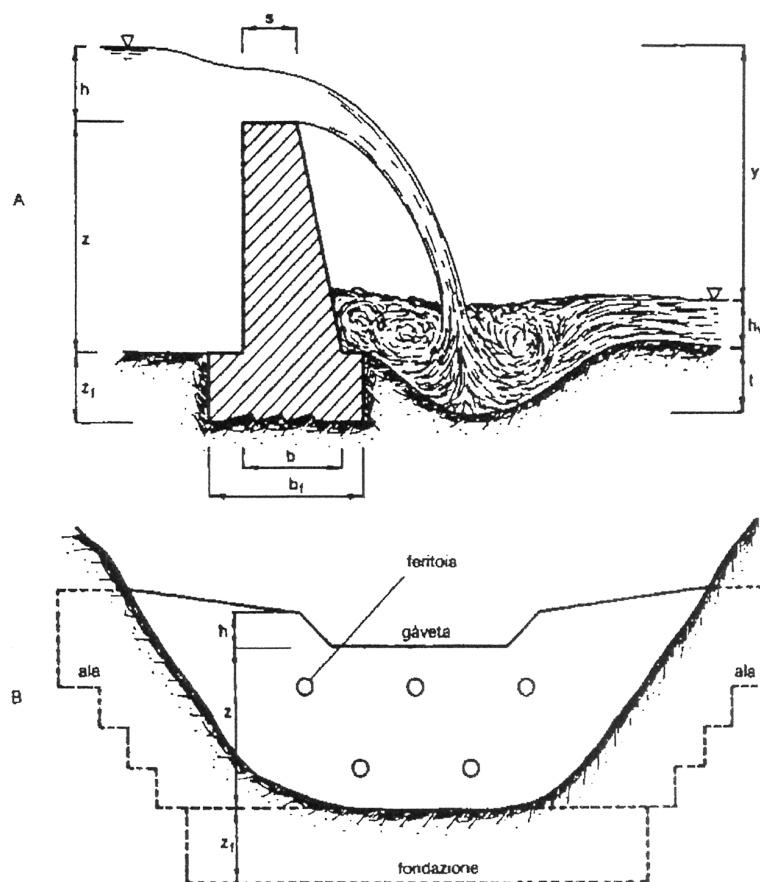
Briglia vista in sezione (a) e frontalmente (b).
